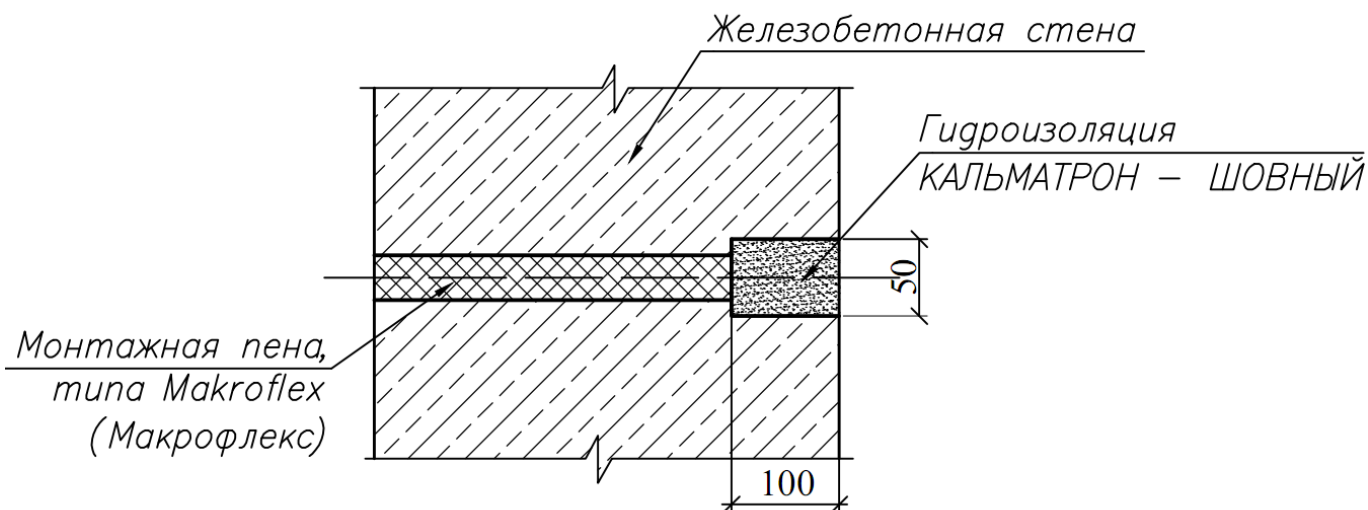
Узел гидроизоляции отверстий в бетонных конструкциях после демонтажа опалубки
